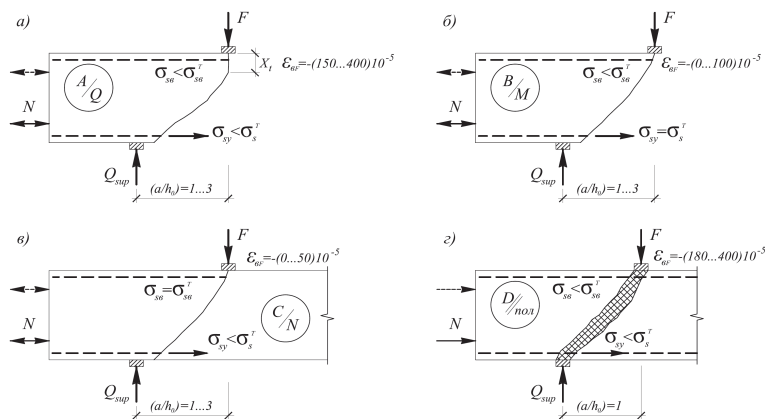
Можливі схеми руйнування припорних ділянок позакентрово розтягнутих або стиснутих залізобетонних балок від переважної дії поперечної сили (а), згинального моменту (б), поздовжньої сили (в), за похилою стислою смугою (г).
